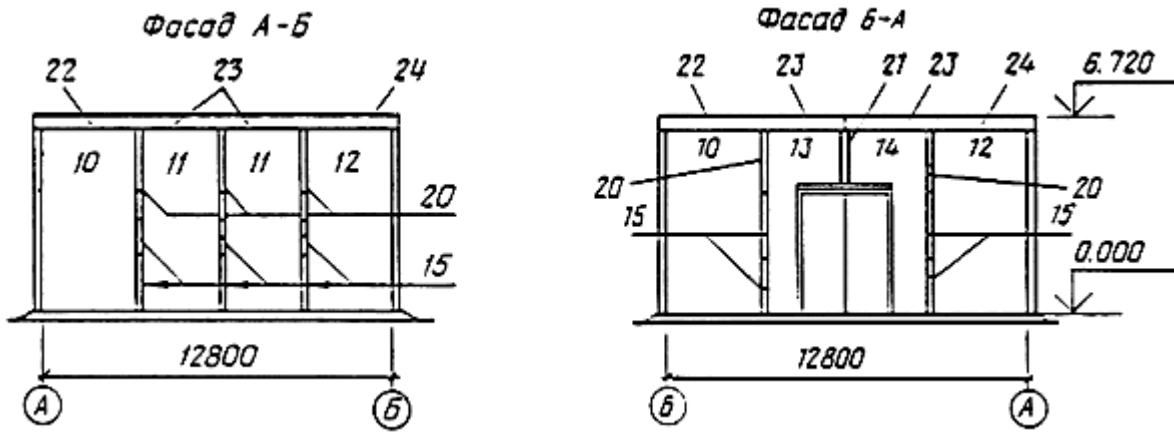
Общий вид здания и схема расположения монтажных элементов (фасад А-Б и Б-А)
